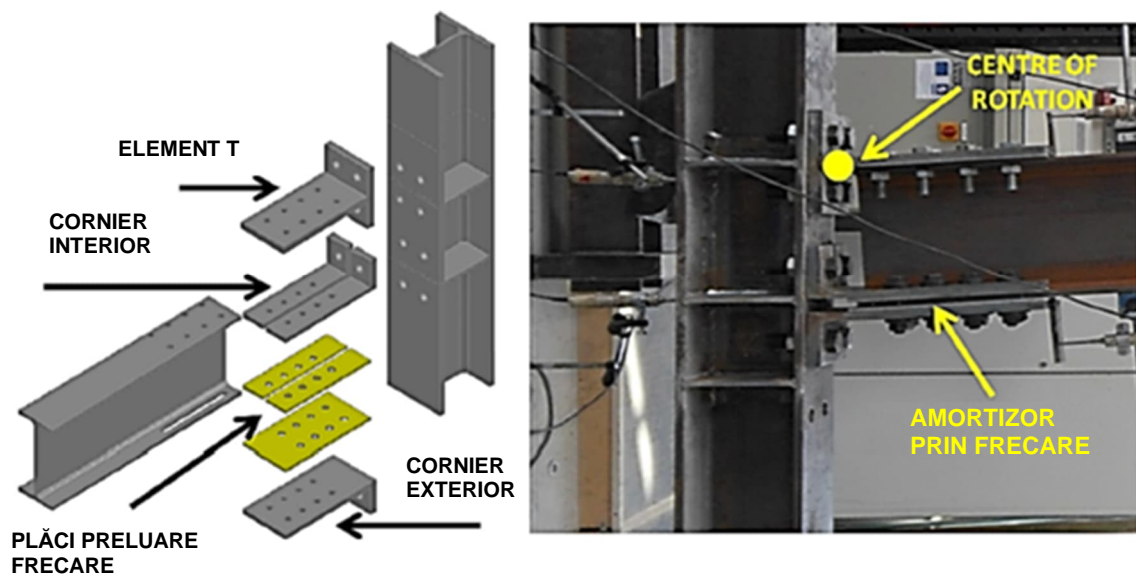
Îmbinare grindă-stâlp echipată cu amortizor prin frecare [63]
